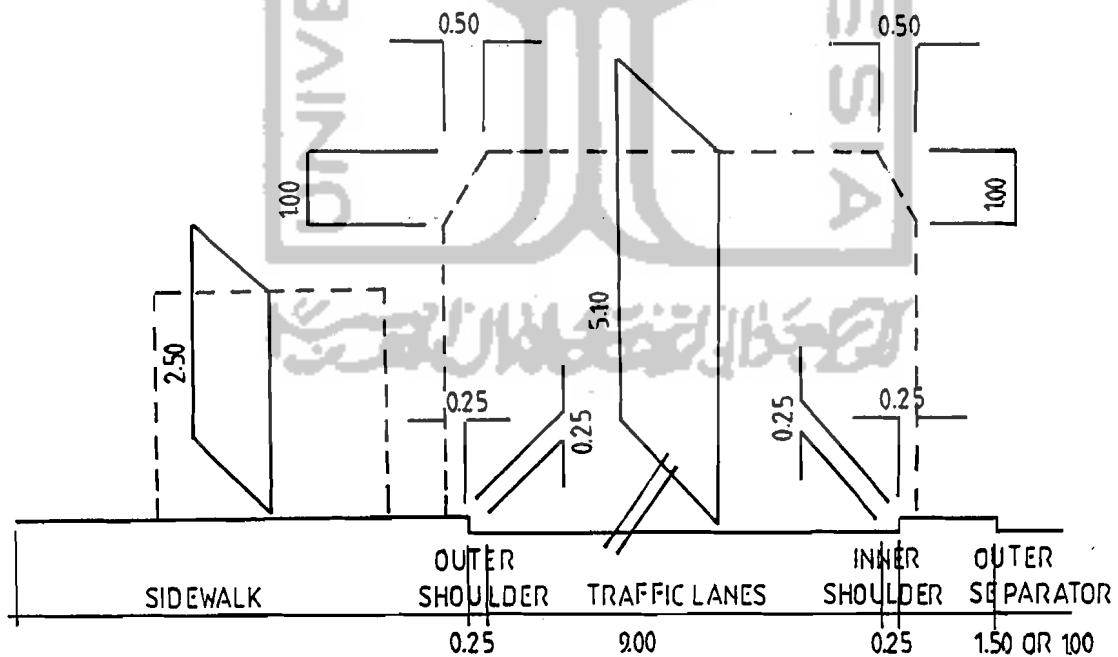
Ruang kebebasan Horizontal and Vertikal
